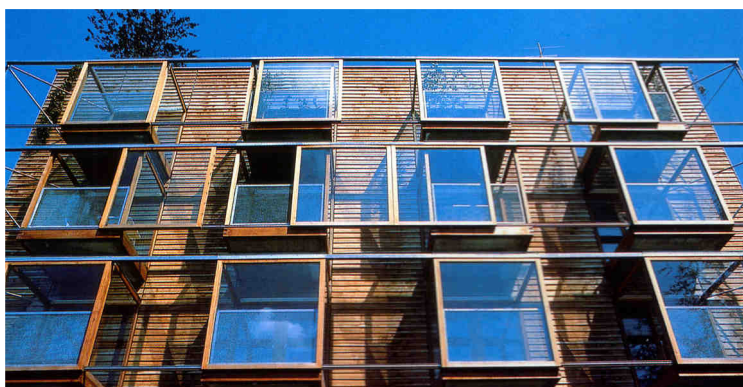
Fachada de madeira com painéis deslizantes de vidro.
